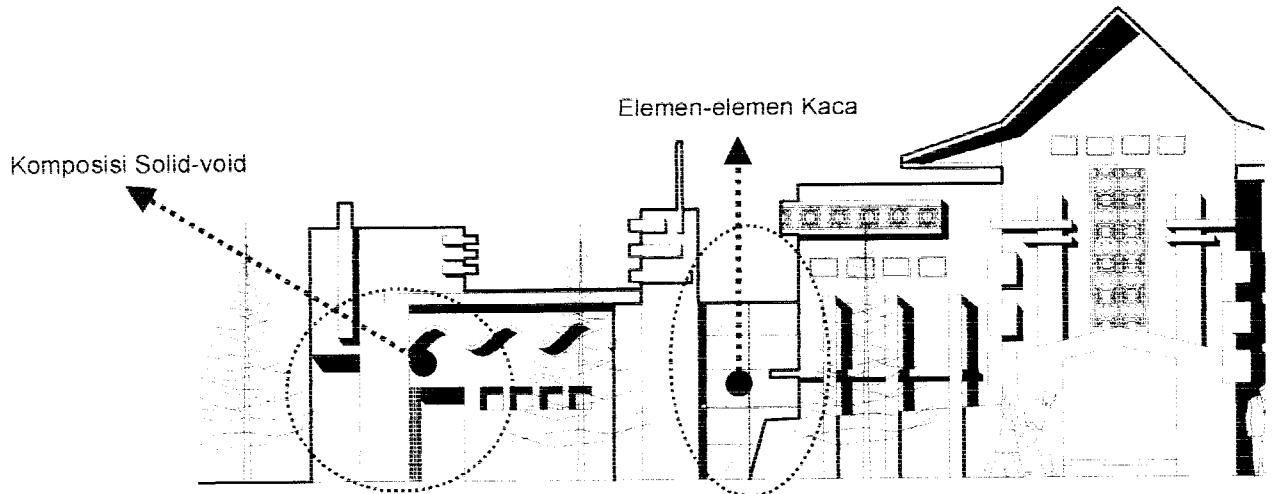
Penerapan simbol dan ornamen pada fasade bangunan
